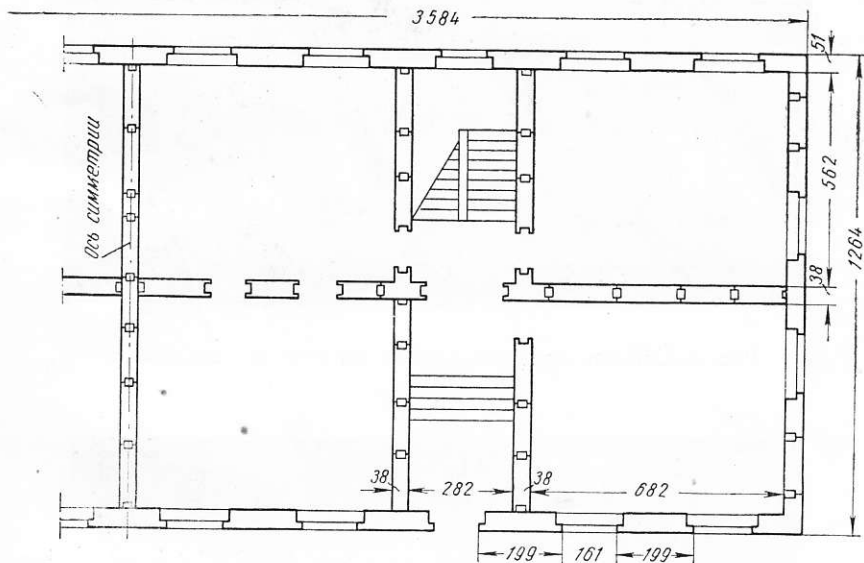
План стен крупноблочного многоэтажного жилого дома для 8—9-балльных сейсмических районов
